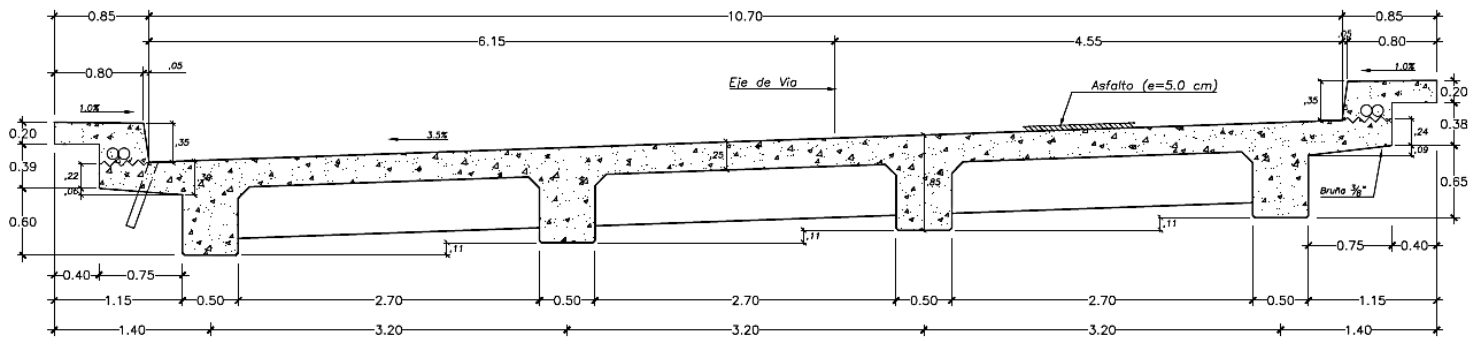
Sección transversal del Puente El Tingo (*Fuente: E.T.*)
